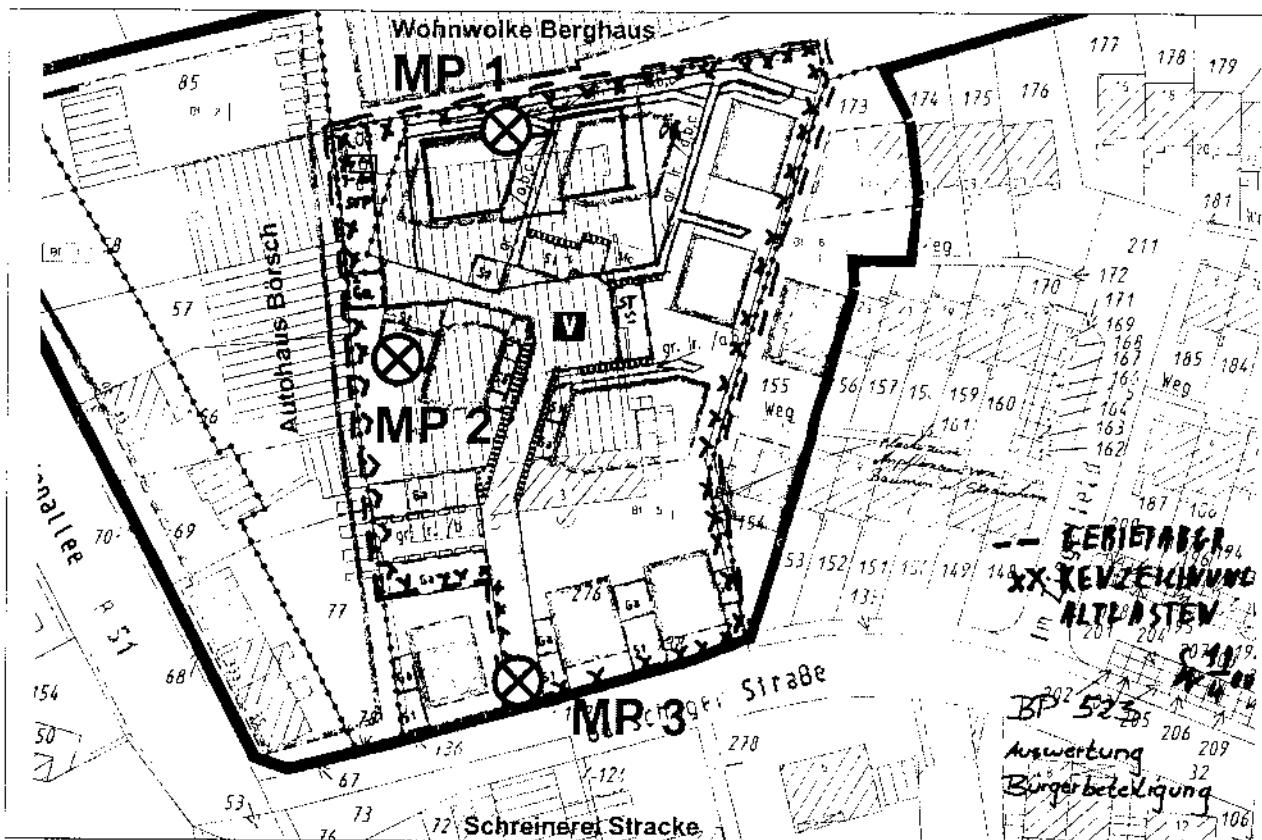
Plangebiet mit geplanter Gebäudekonstellation und einskizzierten Messpunkten (Maßstab 1:1250)
